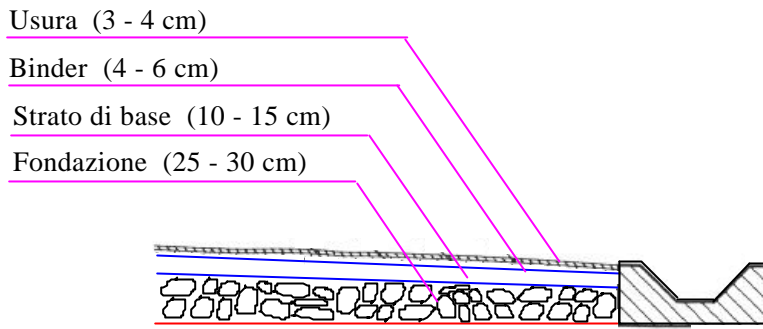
Schema di una pavimentazione flessibile di tipo moderno.
